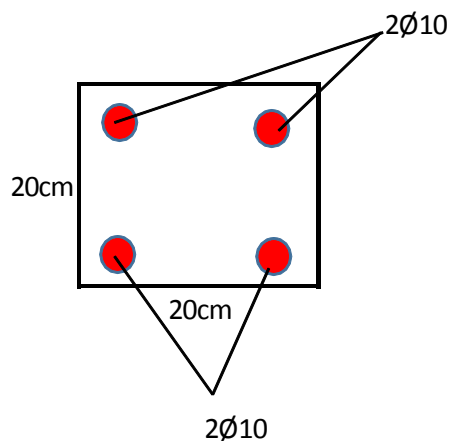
Detalle del acero longitudinal de la viga de cimentación.
